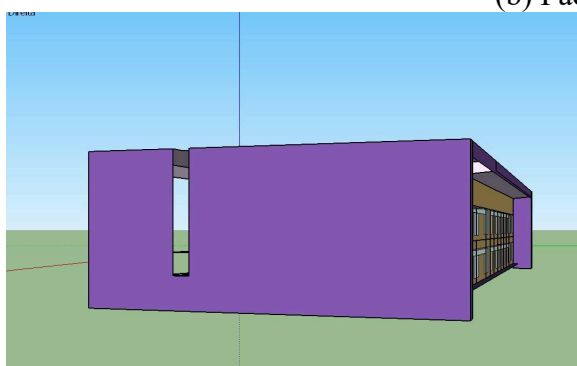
Modelagem do Centro de Pesquisa, fachadas individuais
